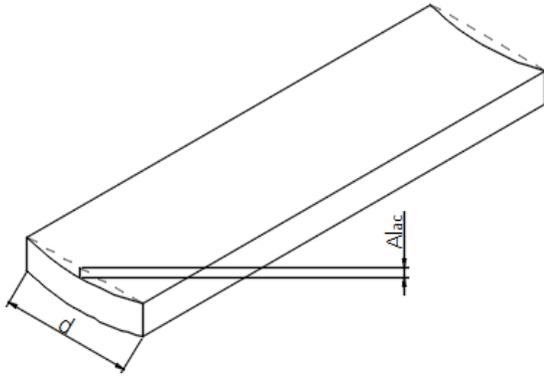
Medición de la acanaladura (A_{ac})
